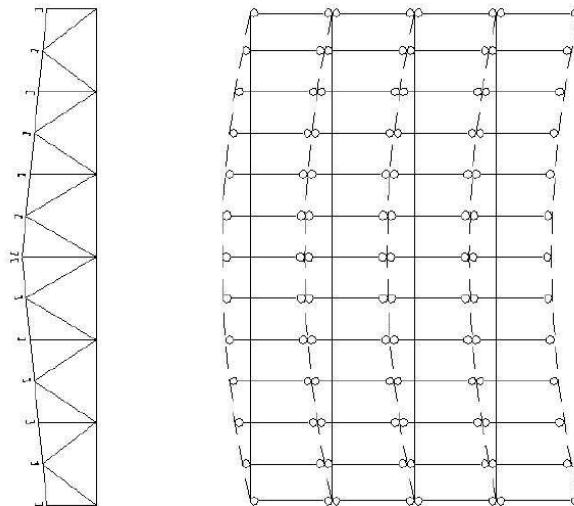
Потеря устойчивости верхних поясов ферм в покрытии без связей.
